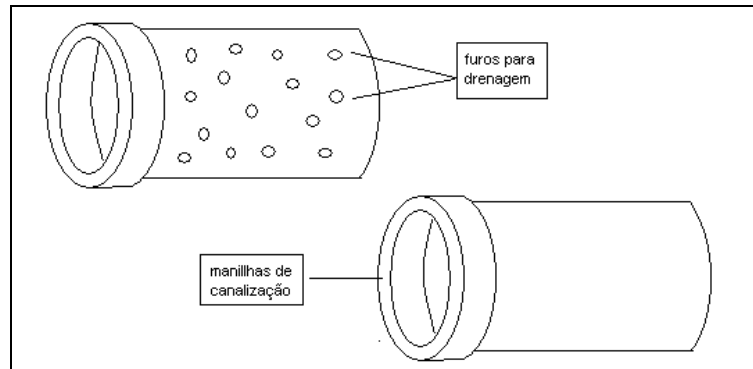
Manilhas para canalização - estrutura comum em obras de drenagem, devem ser enterradas com caída de nível de aproximadamente 4%
